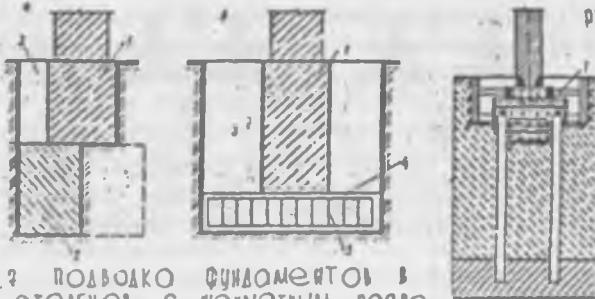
ПОДВОДКА ФУНДАМЕНТОВ 1-
